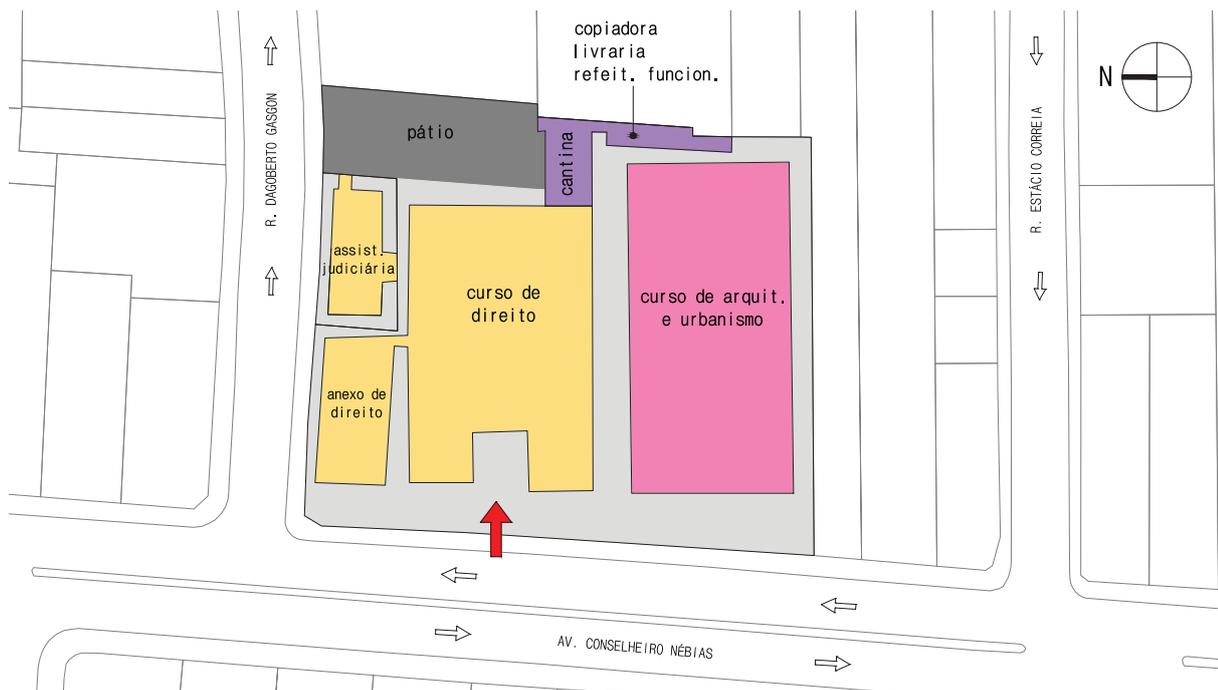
Campus Boqueirão, Planta do Uso Atual
